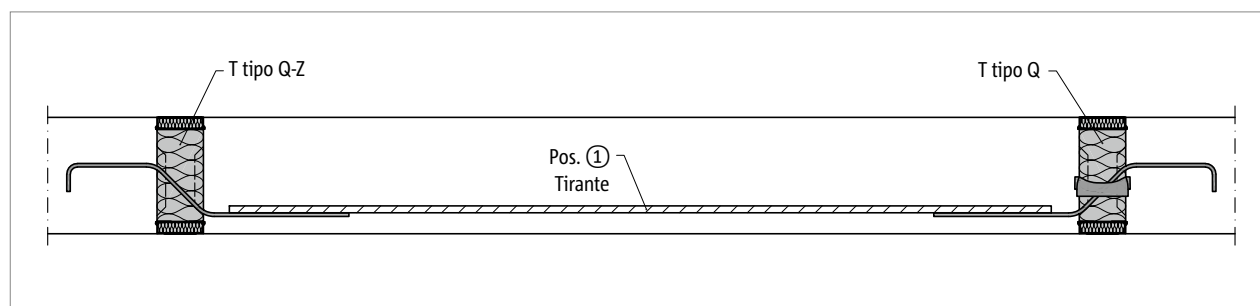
Schöck Isokorb® T tipo Q-Z-V1 - Q-Z-V4, Q-V1 - Q-V4: sezione A-A; soletta in calcestruzzo armato monodirezionale
